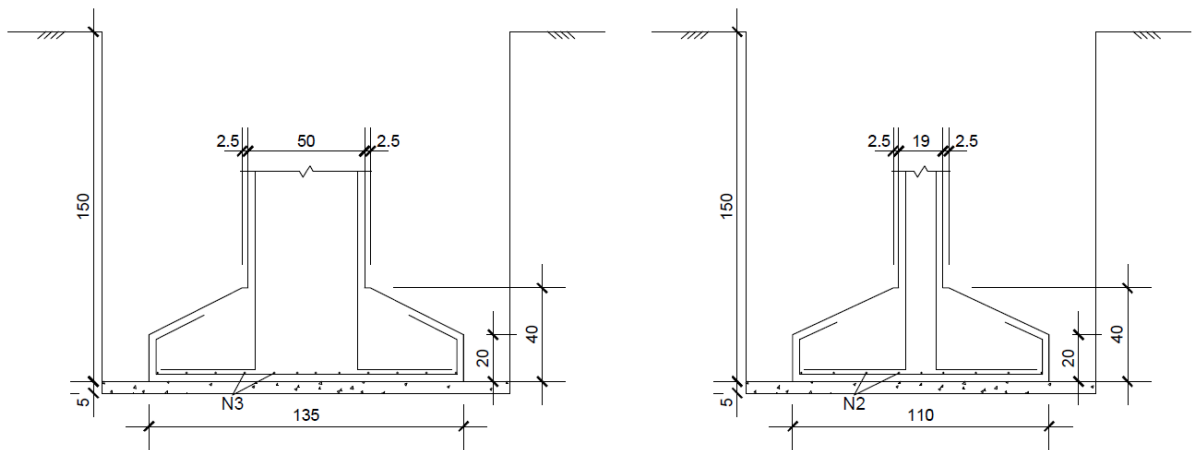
Detalhamento da sapata do pilar com maior carregamento (casa de alto padrão)
